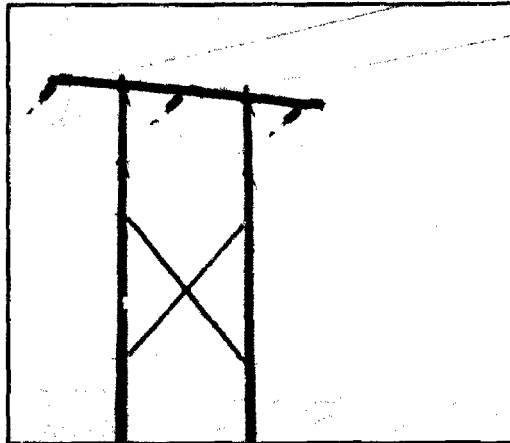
Estructuras de madera de la línea de alta tensión en 138 kV Tipo Anclaje
